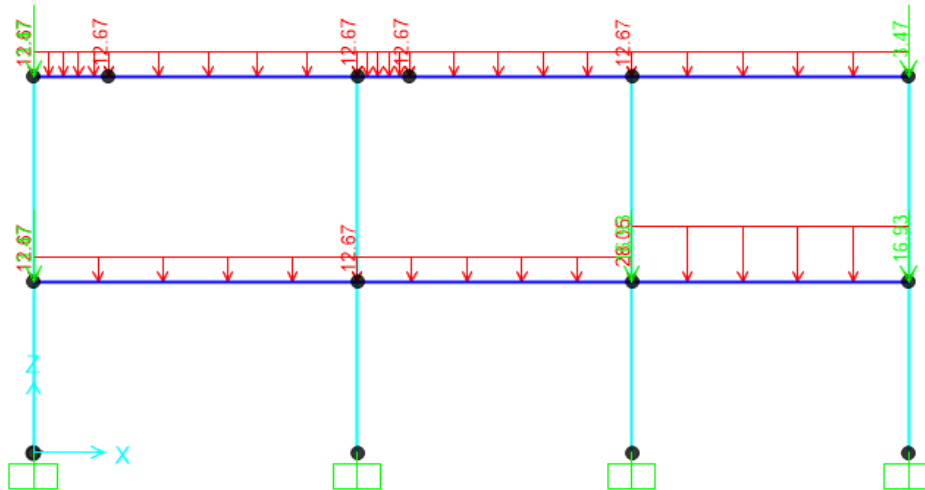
Esquema de cargas permanentes sobre el pórtico 21-16-10-4.
